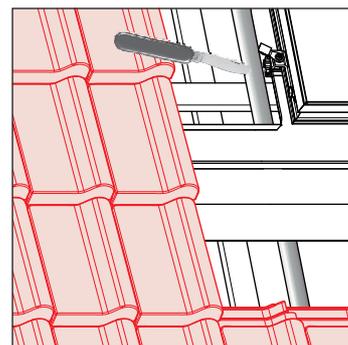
Passage de la conduite de raccordement au-dessous du groupe de capteurs solaires
